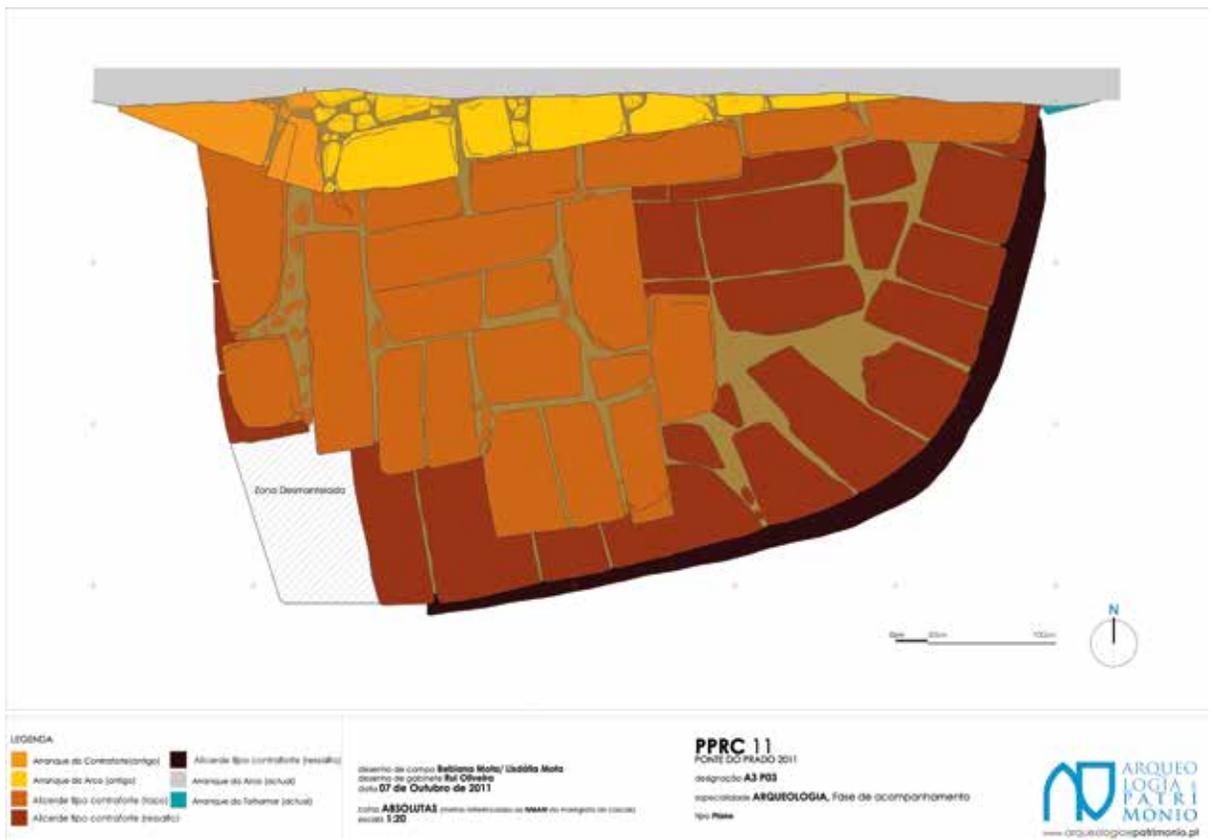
Planimetria das estruturas pré-existentes sob o pilar 3.
